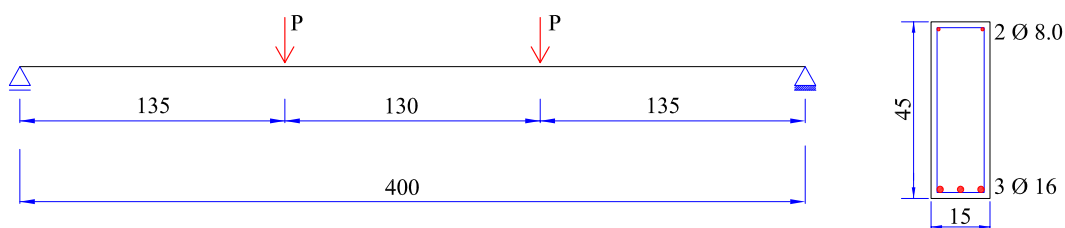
Detalhes da geometria, carregamento e armadura da viga de Farage (1995).
